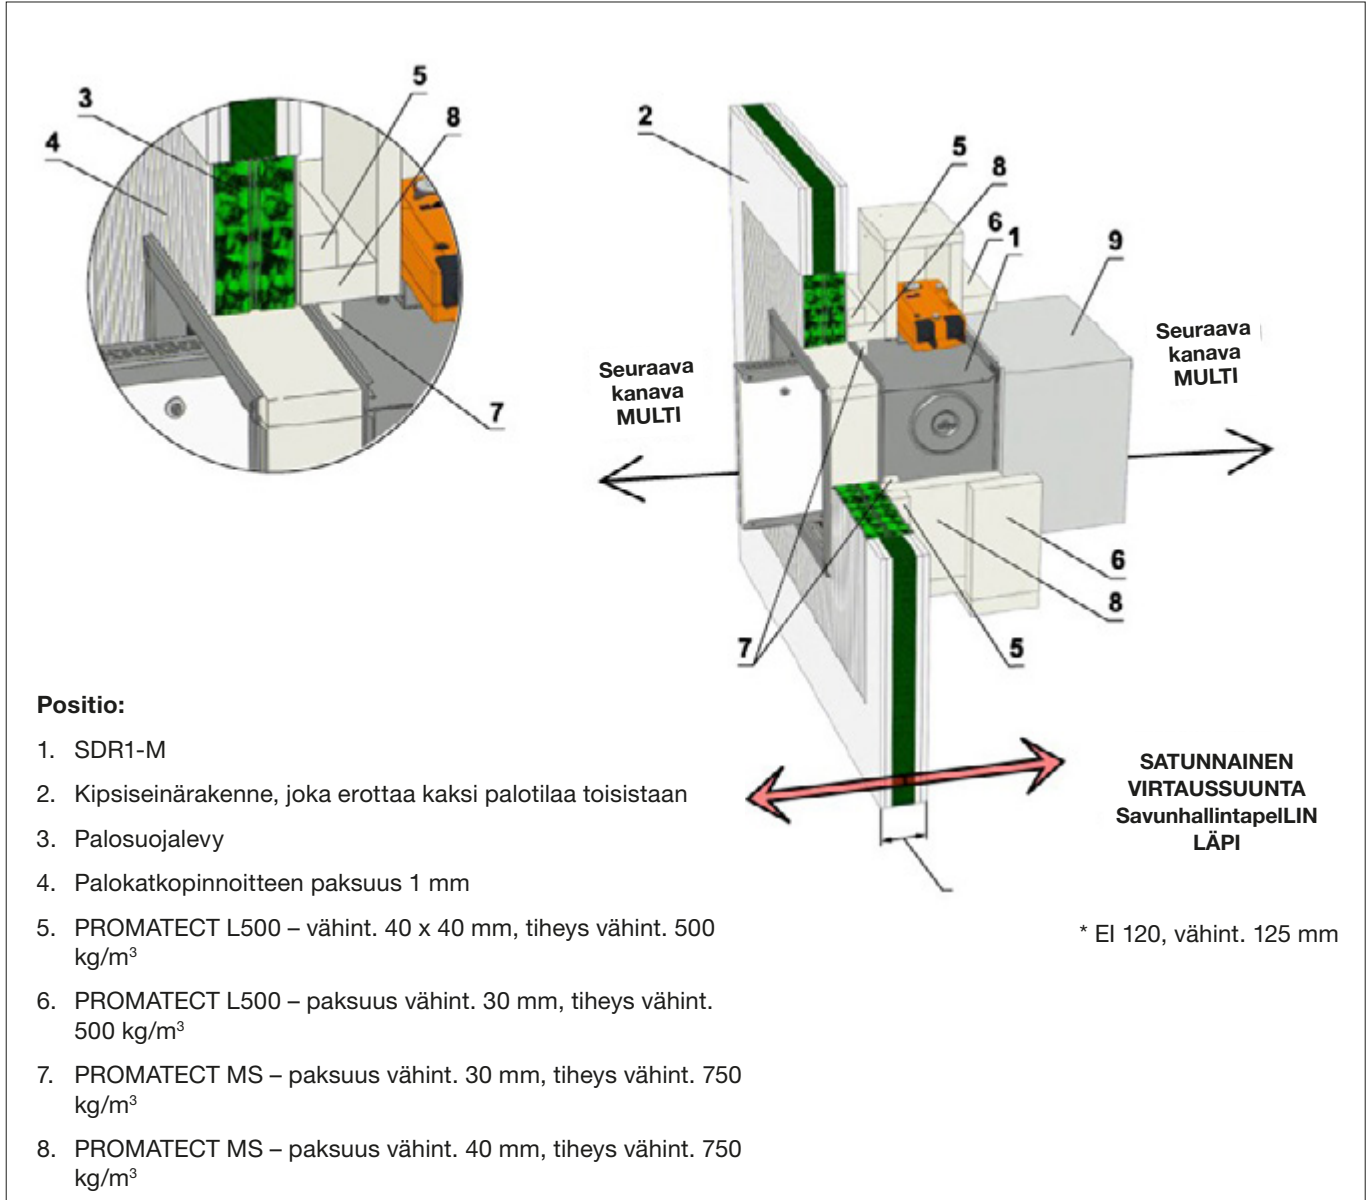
Jakava rakenne usean (MULTI) osaston savunhallintakanavan välillä – eristys kivivillalla – Palosuojalevy
